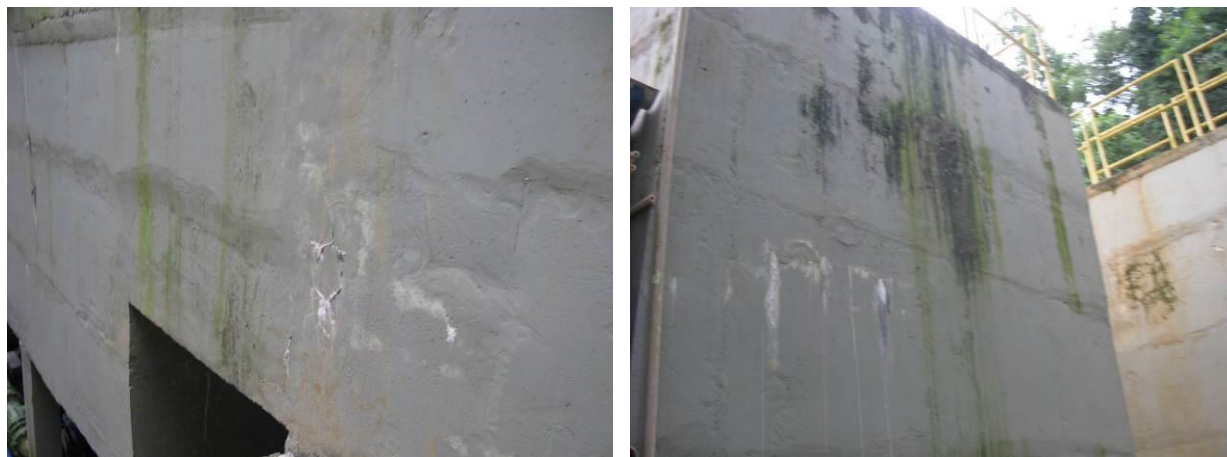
Sinais de infiltração na parede externa do tanque de decantação.
